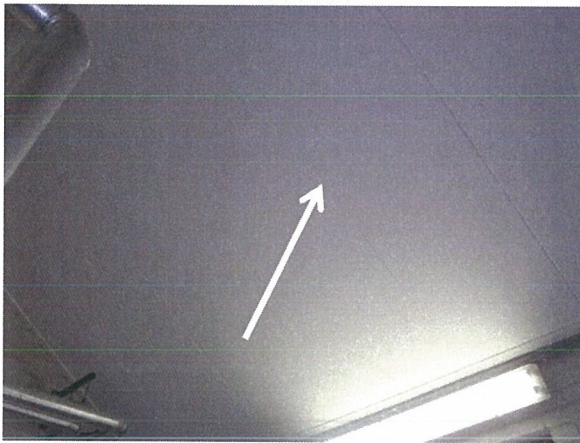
Gebouw AB: ruimtes achter vaste wand-, plafond- en vloerdelen geen onderzoek uitgevoerd.
